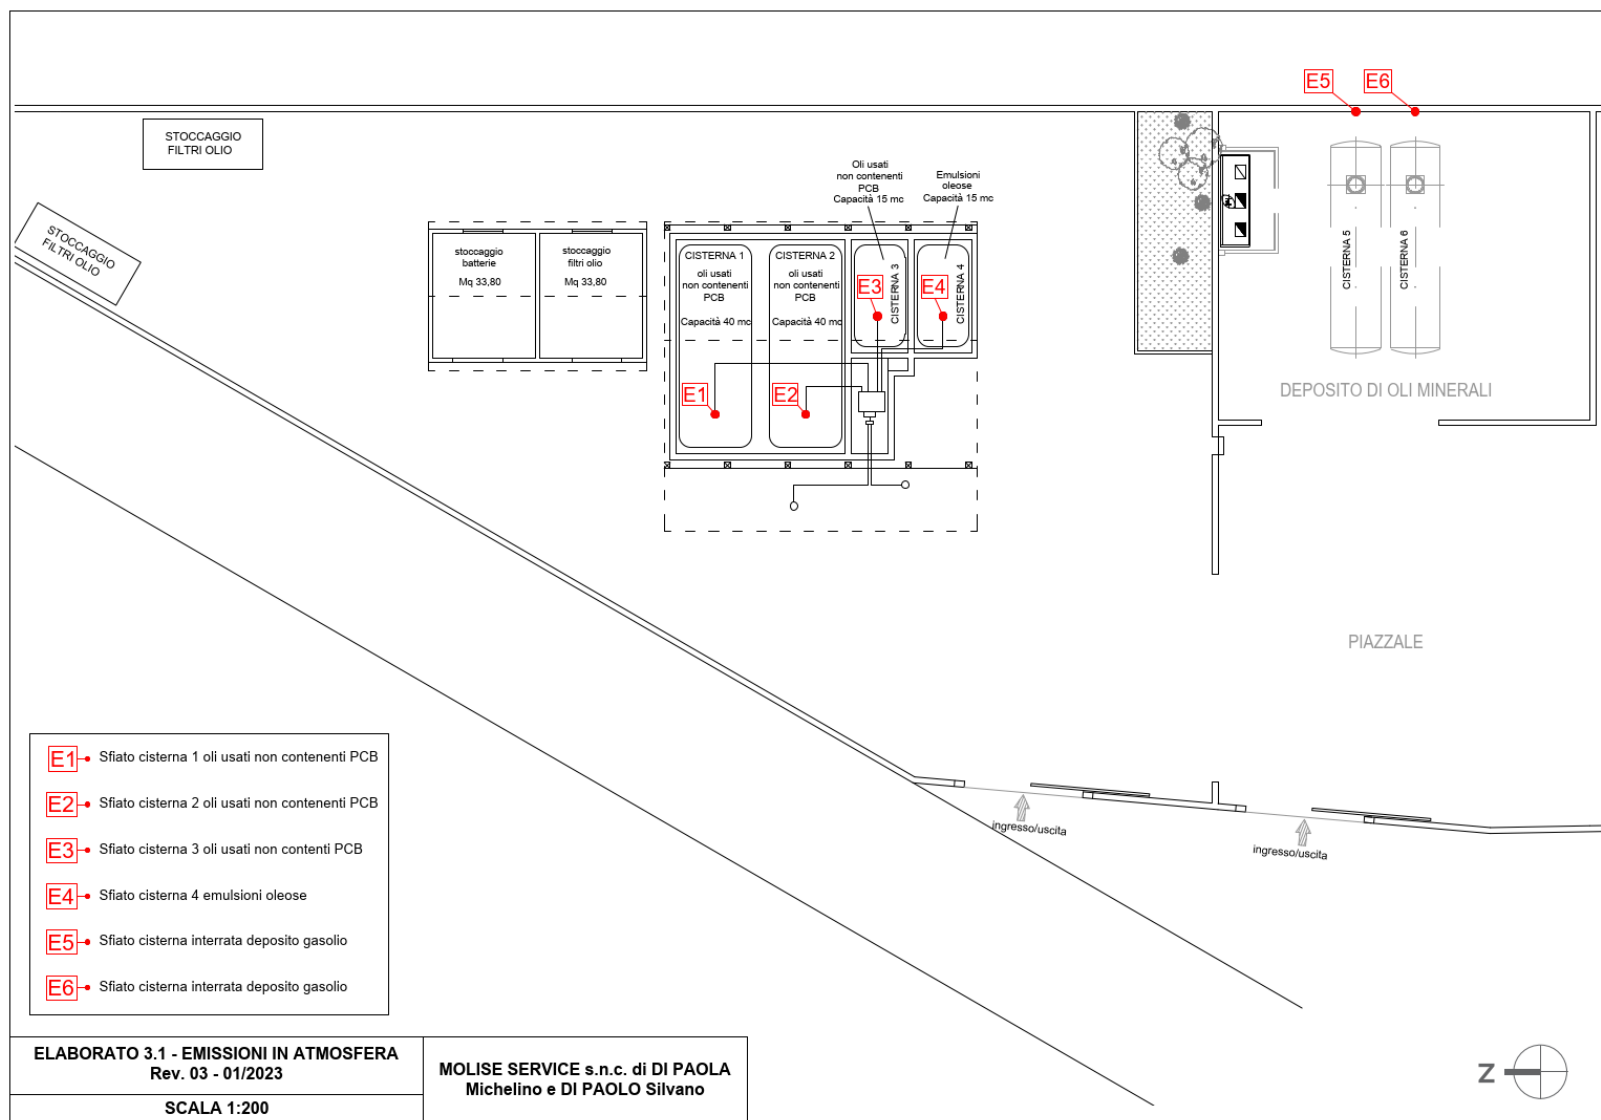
planimetria generale di stabilimento con indicazione dei punti di emissioni in atmosfera: assetto "ante operam"
